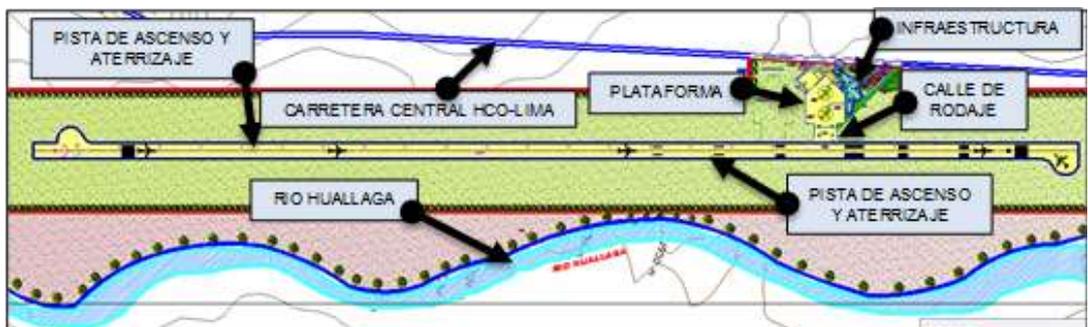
Zona de pistas; Fuente: plano de zonificación general AG-01
